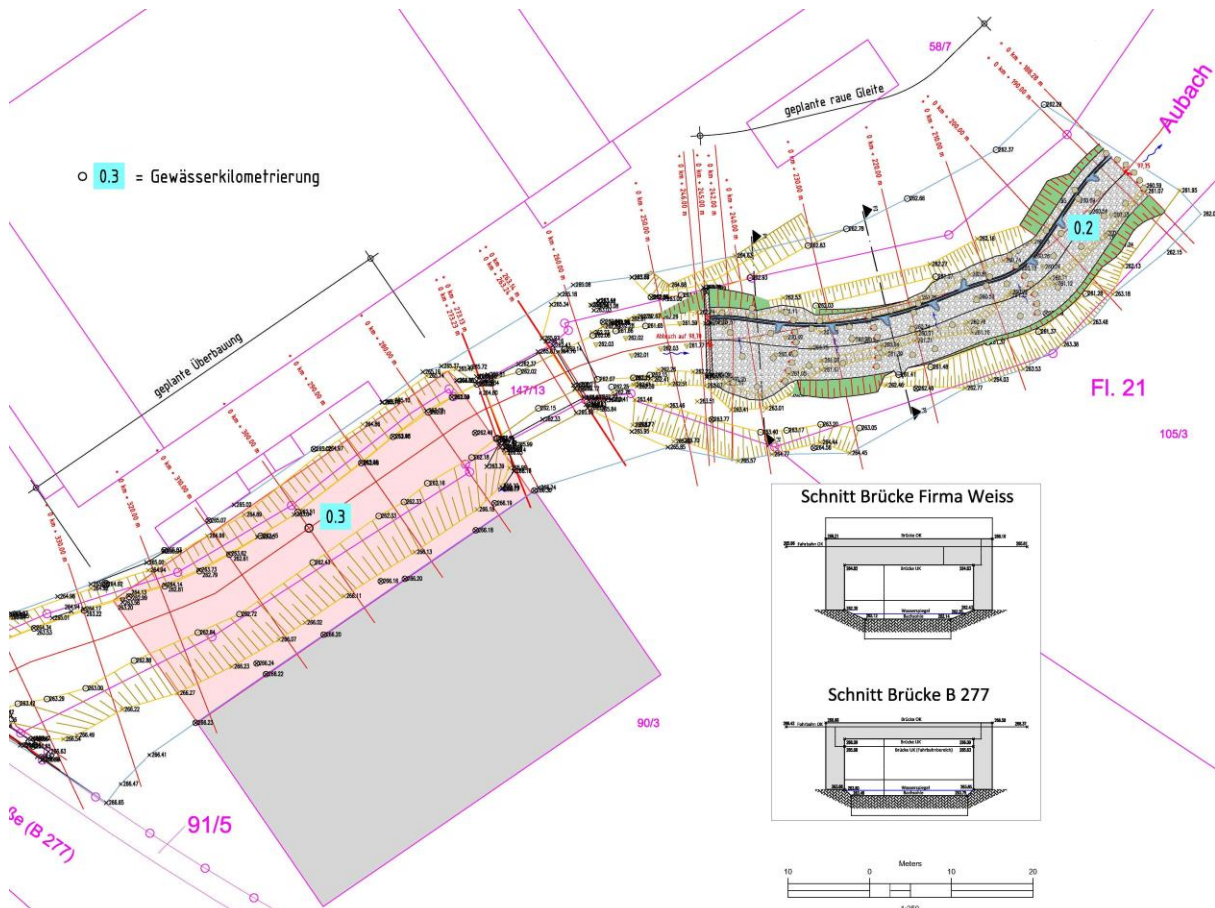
Lageplan der Fachplanung mit Darstellung der Rauen Gleite und dem geplanten überbauten Bereich des Aubaches, Quelle: Wasserrechtliches Genehmigungsverfahren 2023, erstellt Büro Falkenhahn, Fulda
